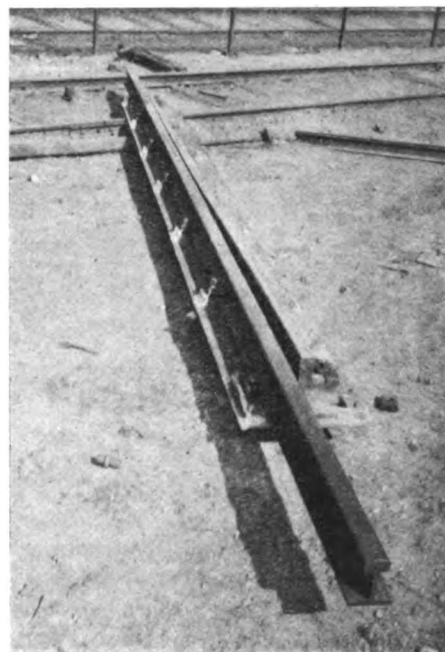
Halbe Weiche. Gleitstähle und Drehpunktplatte sind angeschweißt.
